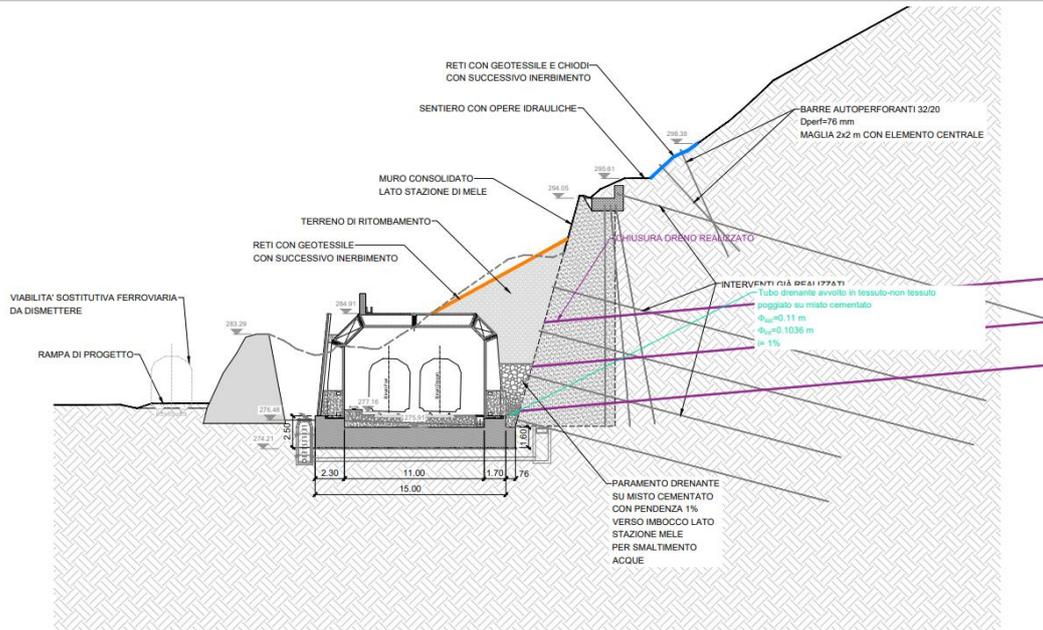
Stralcio di una sezione di intervento sul muro consolidato lato stazione Mele.
